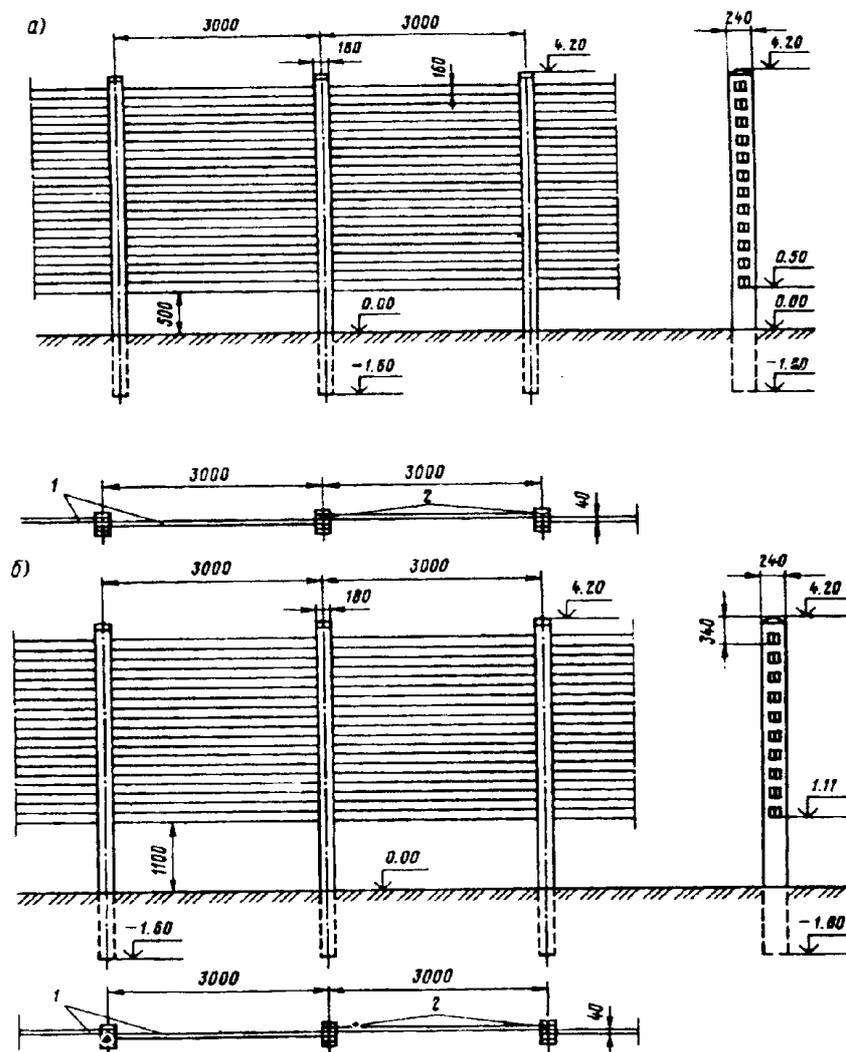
Схемы путевого (а) и полевого (б) железобетонных снегозадерживающих заборов сборной конструкции: 1 — железобетонные доски; 2 — железобетонные опоры
